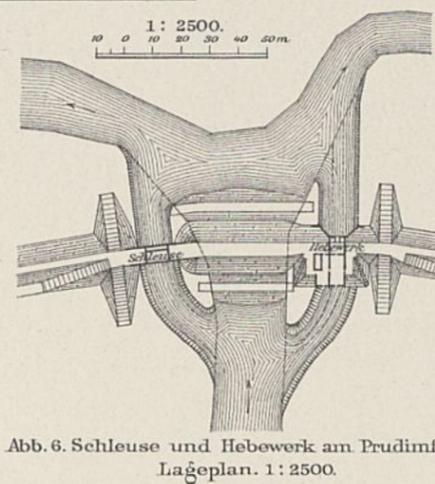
Schleuse und Hebewerk am Prudimfluss. Lageplan. 1: 2500.
